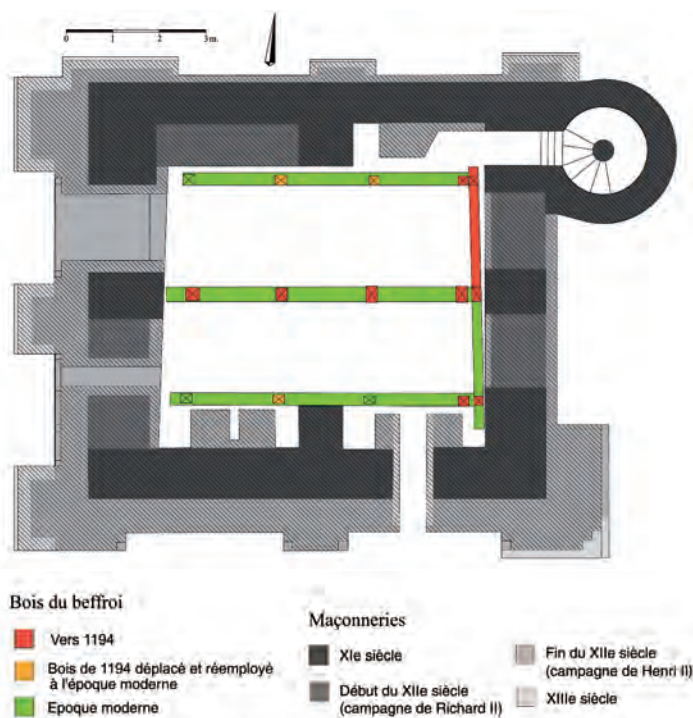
Plan du beffroi de la tour nord au niveau des sablières basses.
